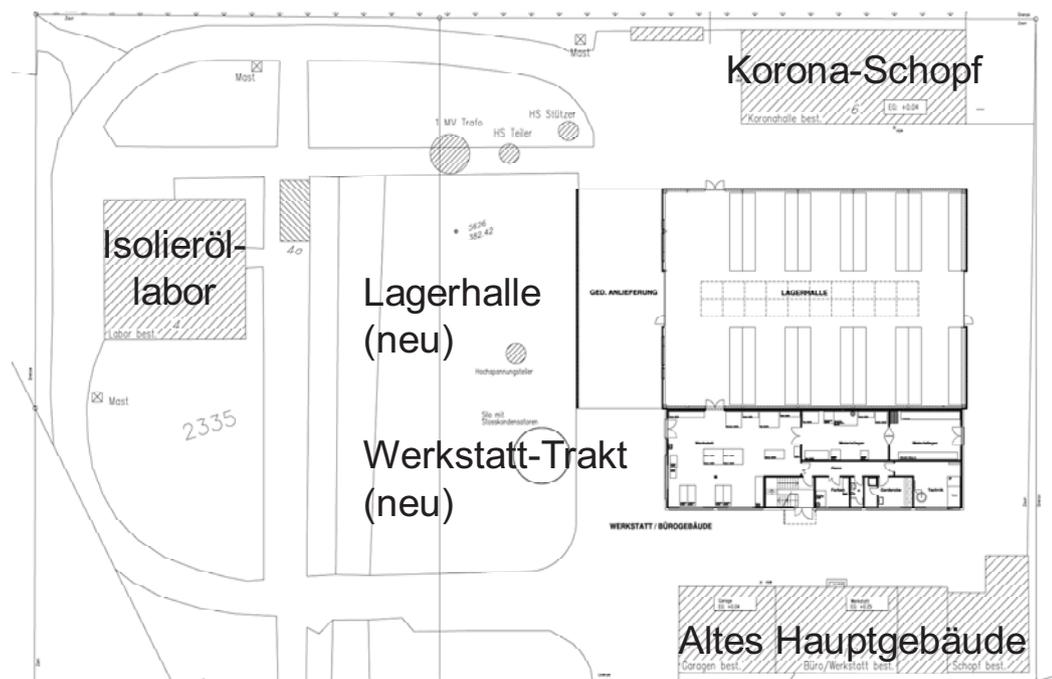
Grundriss der neuen Betriebsgebäude in der Versuchsstation Däniken
